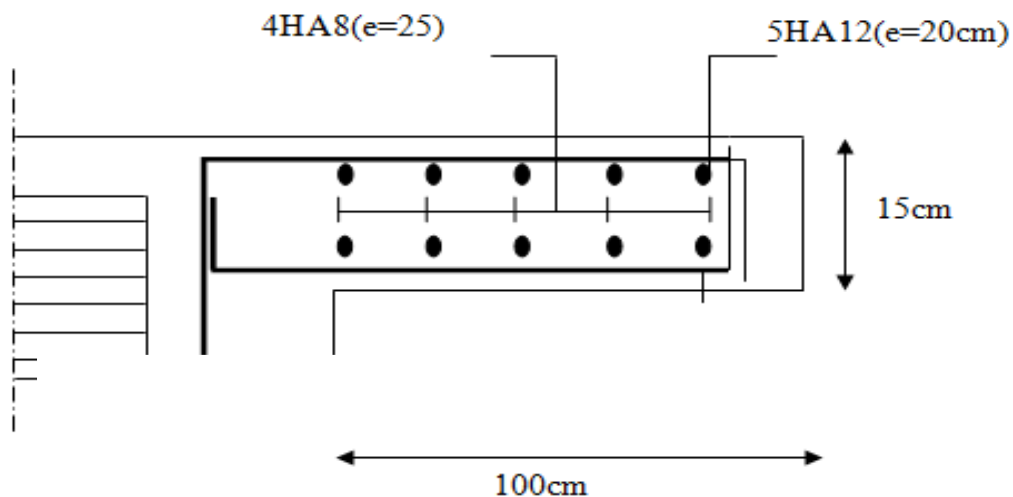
Ferrailage du balcon reposant sur deux appuis
